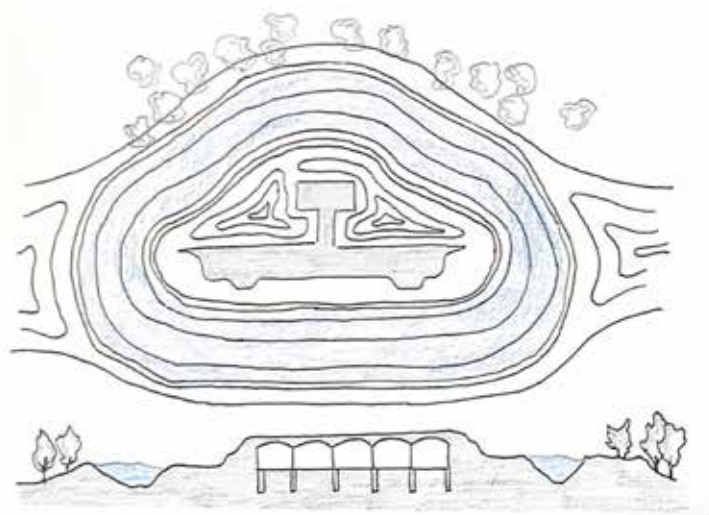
Esquema en sección corte longitudinal por el conjunto del fuerte. Fuente: Elaboración propia, 2025
